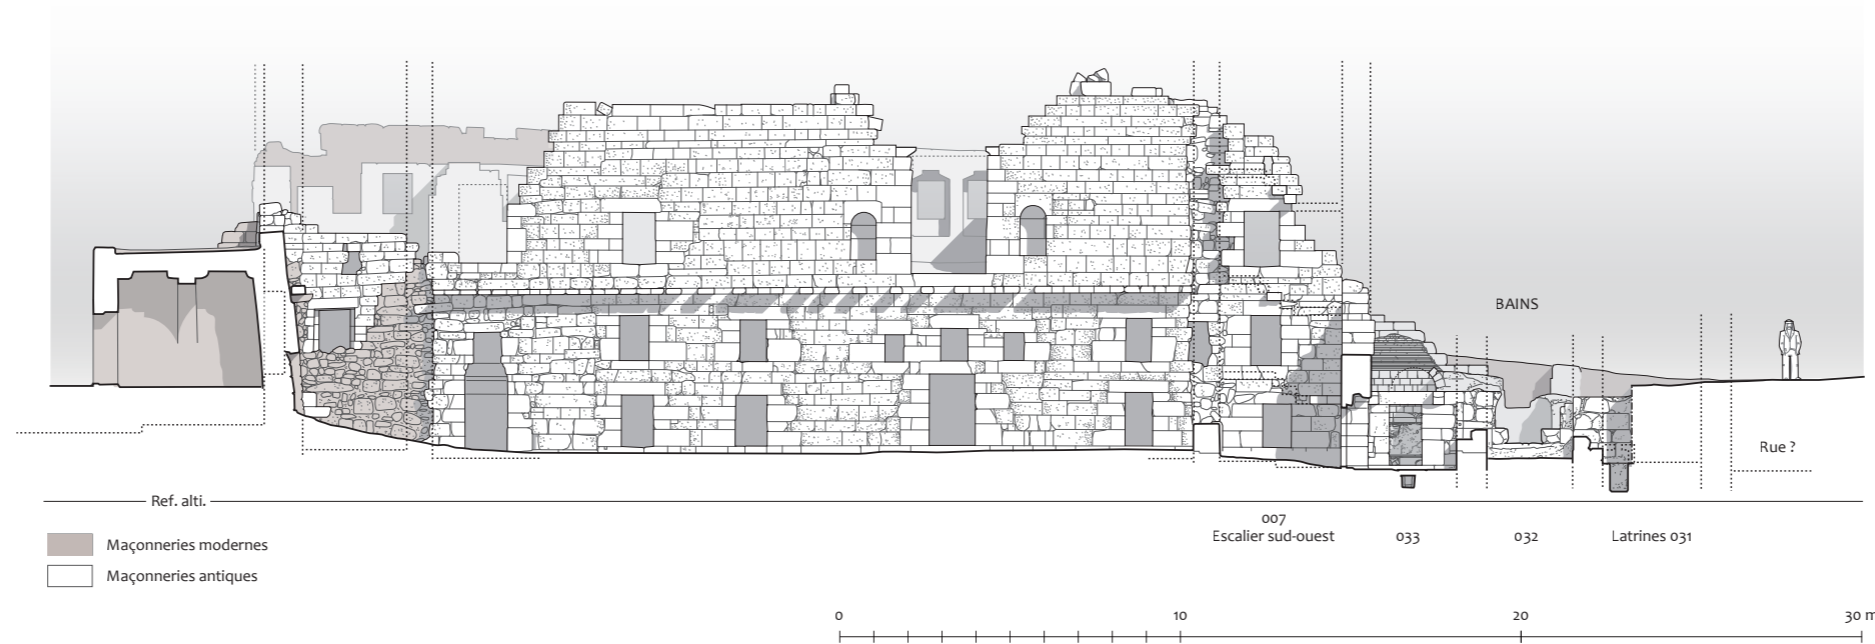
Le « Palais de Trajan », coupe 1, façade sud sur cour. Bâtiment sud (état des lieux 2009, 1/200^e)
